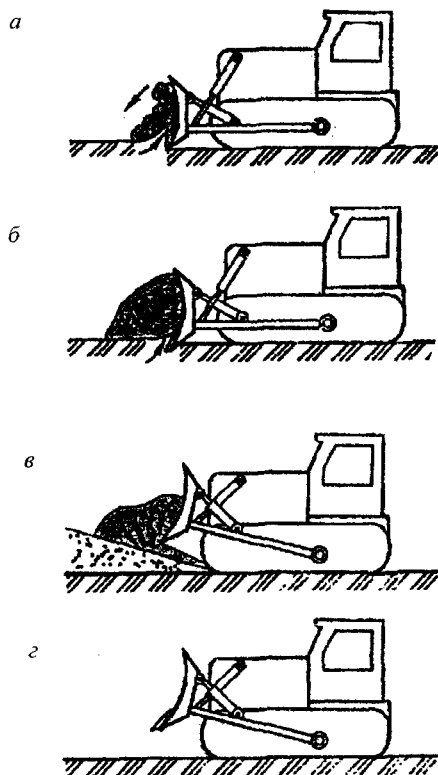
Схемы работы бульдозера при разработке грунтов:
